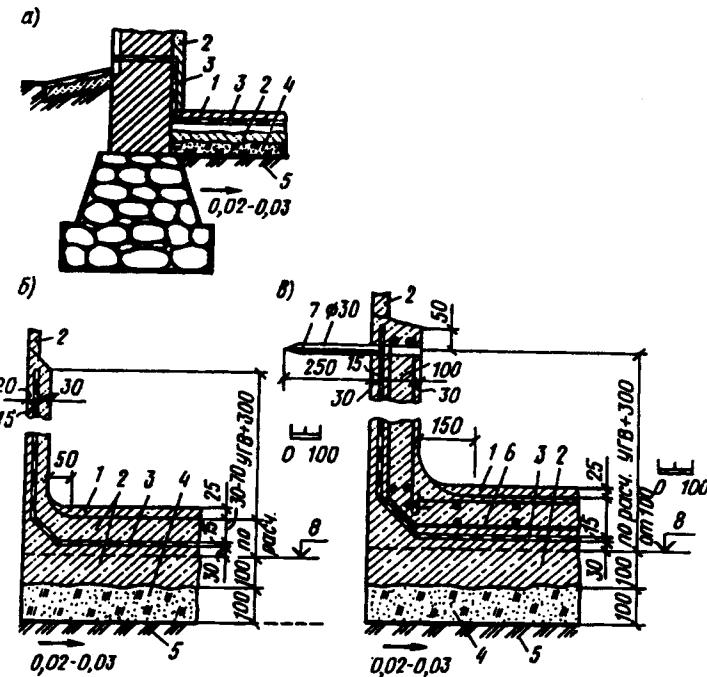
Гидроизоляция помещений, заглубленных в землю
